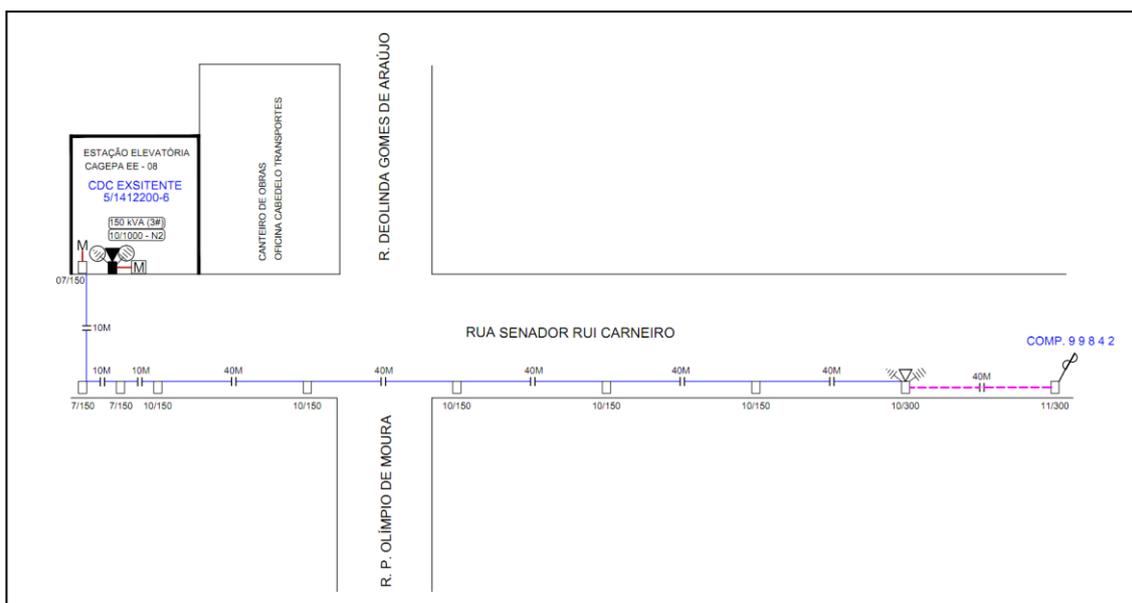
Planta de situação da Cagepa. [Fonte: Da Autora]
